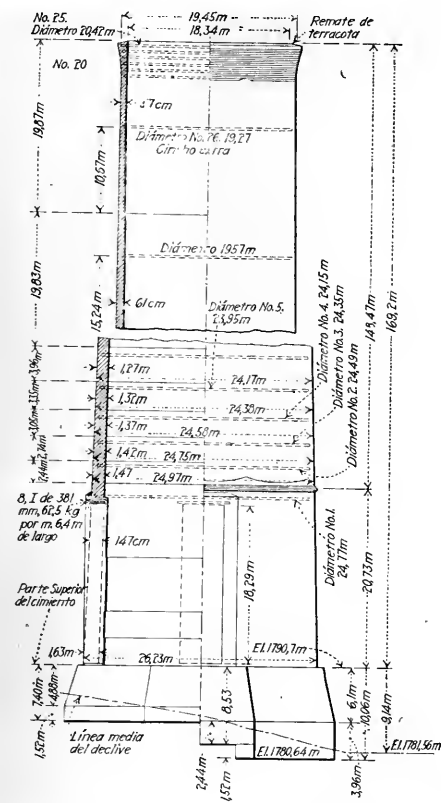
ELEVACIÓN DE LA CHIMENEA
